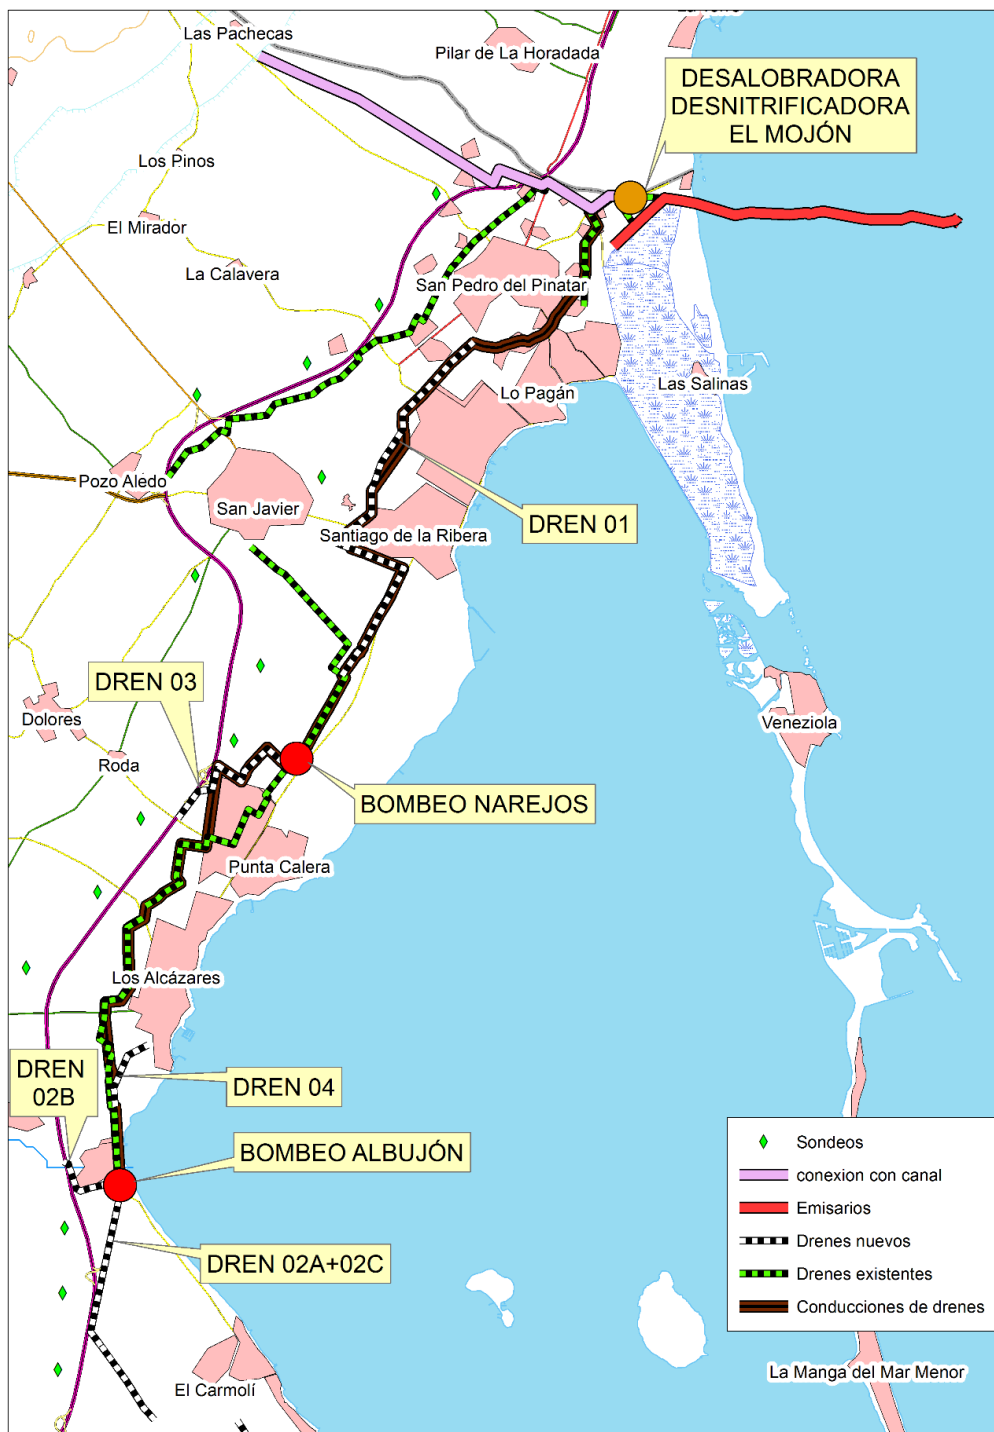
Sistema de drenaje perimetral a diseñar en la zona norte
